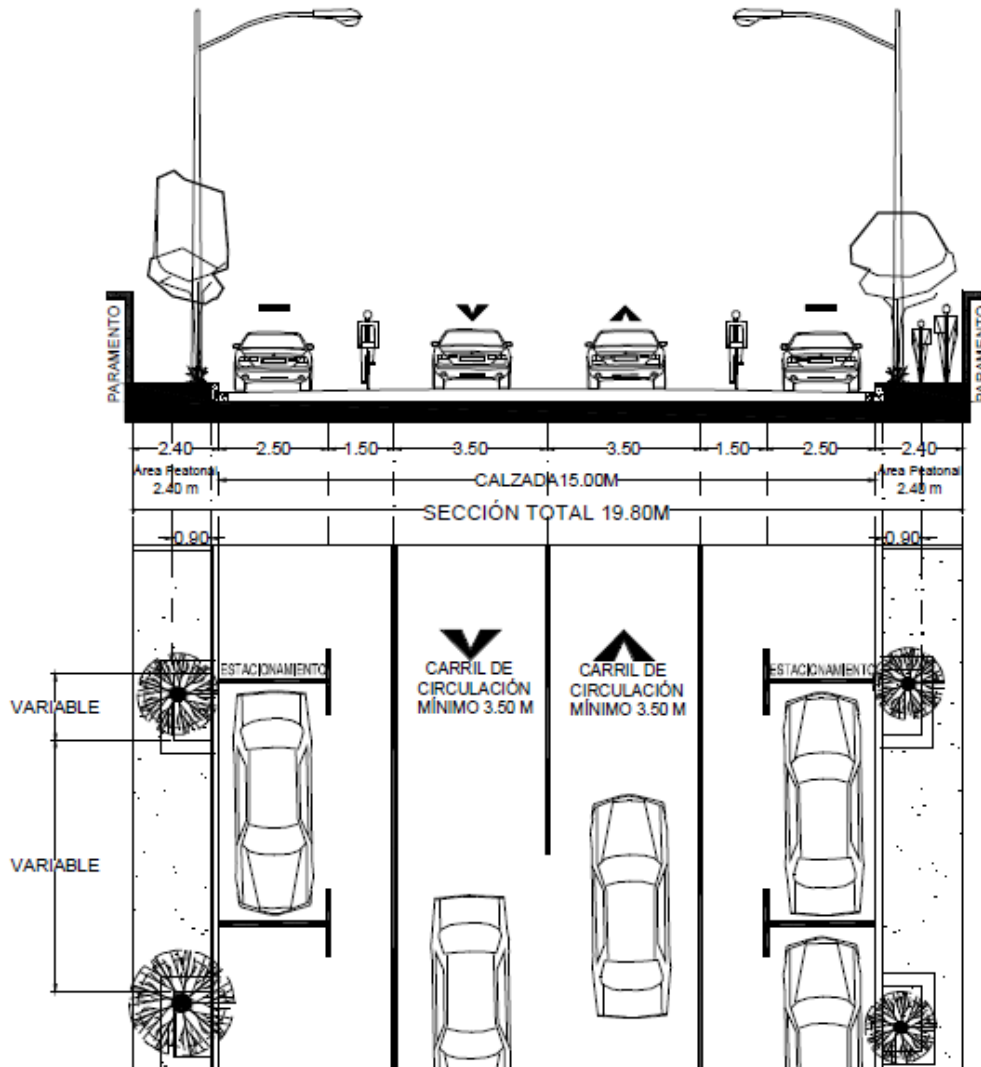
Detalle de sección y planta de vialidad acceso a colonia. Fuente: Normatividad IMPLAN.
